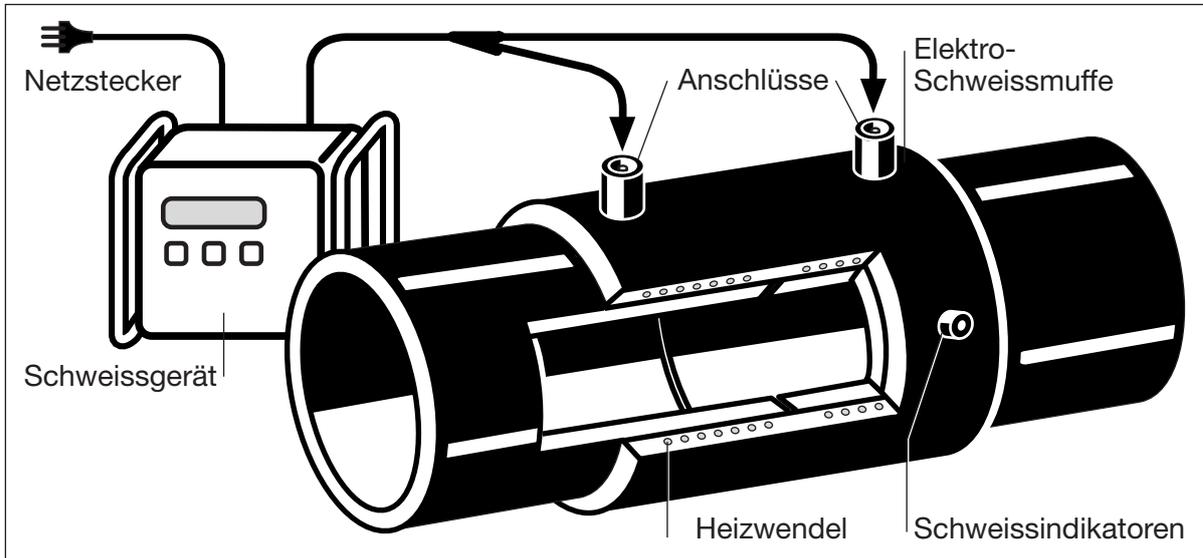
Prinzip der Elektro-Schweissung am Beispiel einer Verbindung mit einer Elektro-Schweissmuffe
